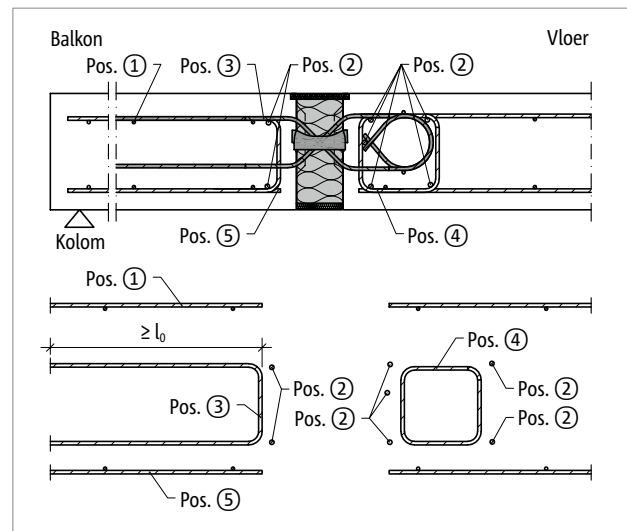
Schöck Isokorb® T type Q-E-V: Bijlegwapening
